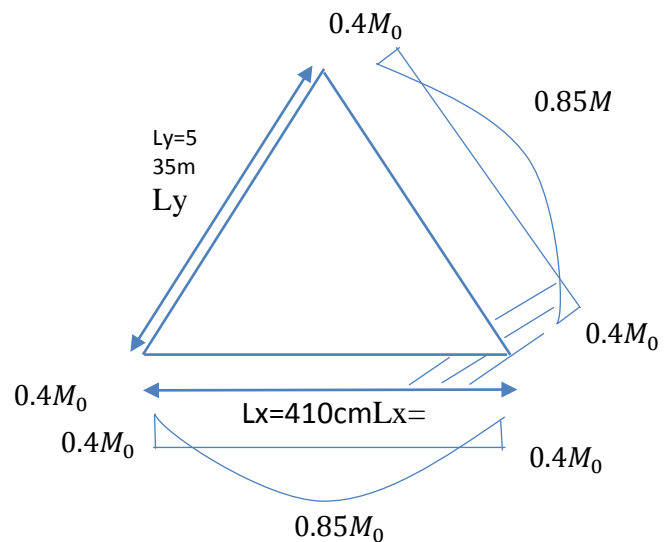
Schéma statique de la dalle pleine (D1)
